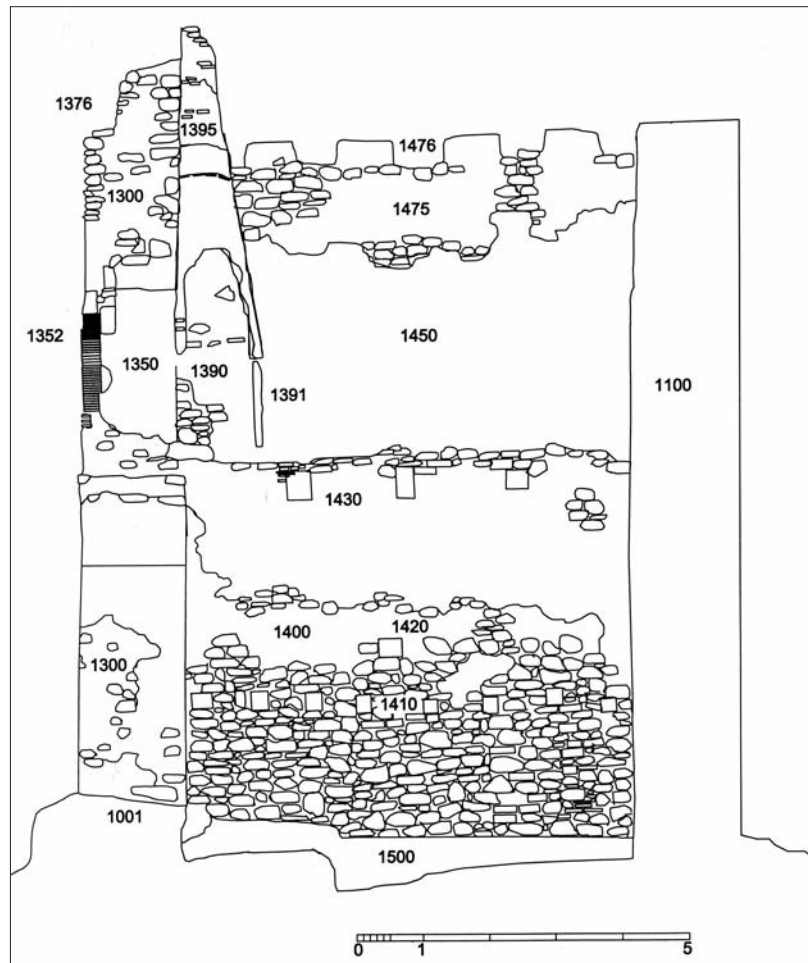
Area 1000. *Donjon*, prospetto interno del muro 1400
